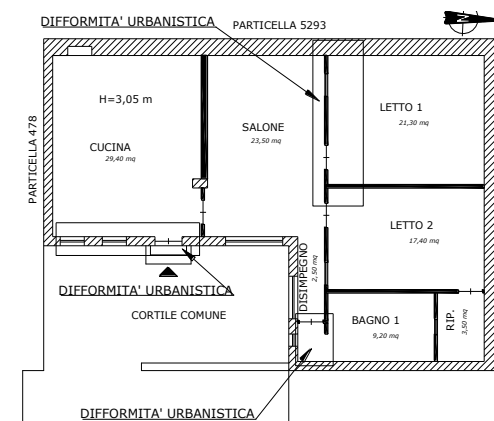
Planimetria appartamento al piano terra con le difformità urbanistiche
